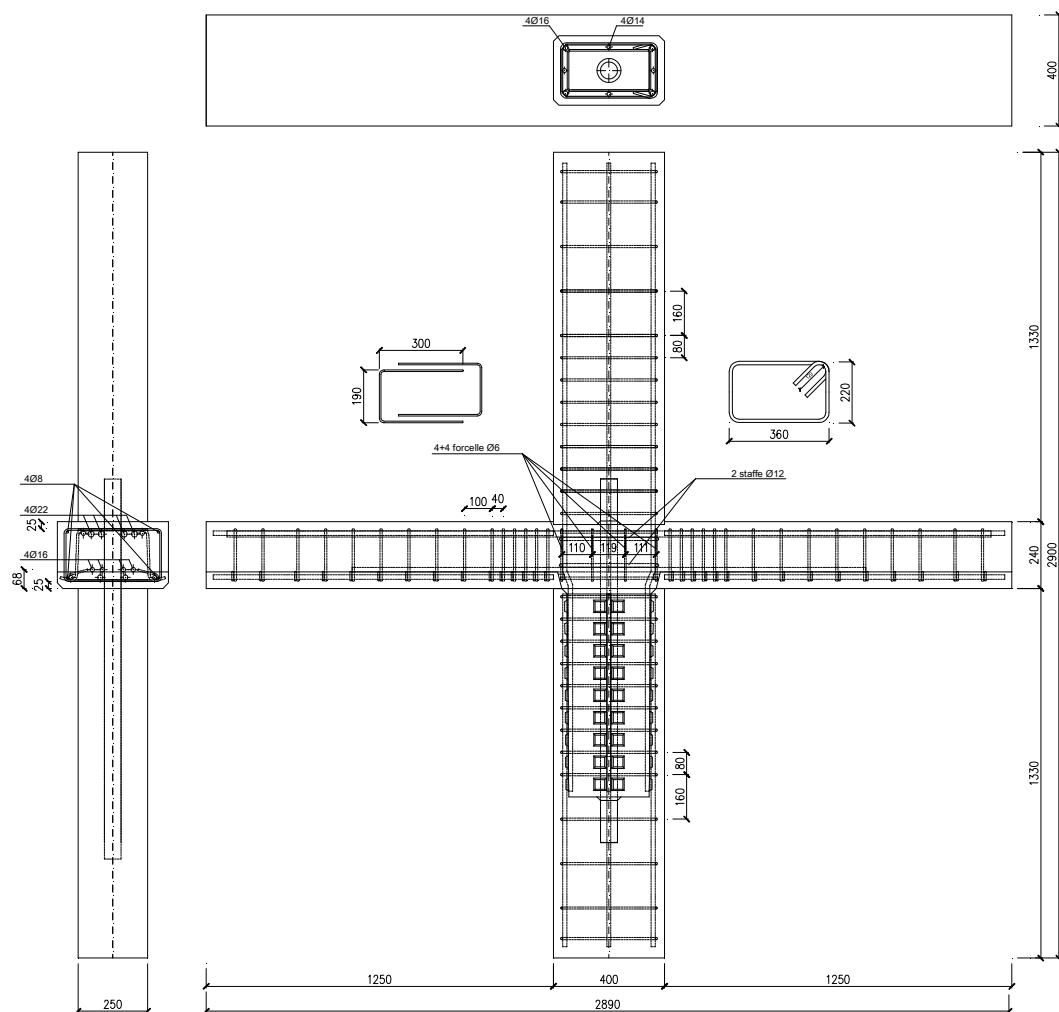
Schema campione prefabbricato TST/5, con pilastro in asse forte
